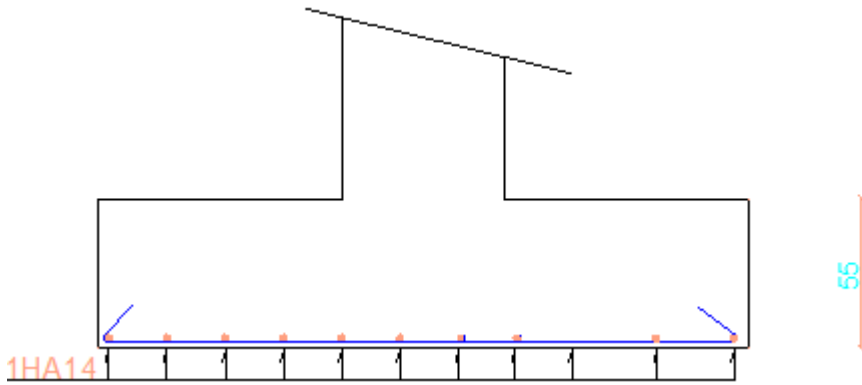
Ferrailage de la semelle intermédiaire dans le sens y-y.
